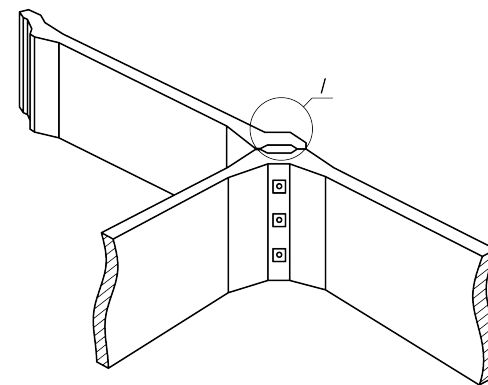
Струбцина опалубка для бетонування вертикальних стиків.
